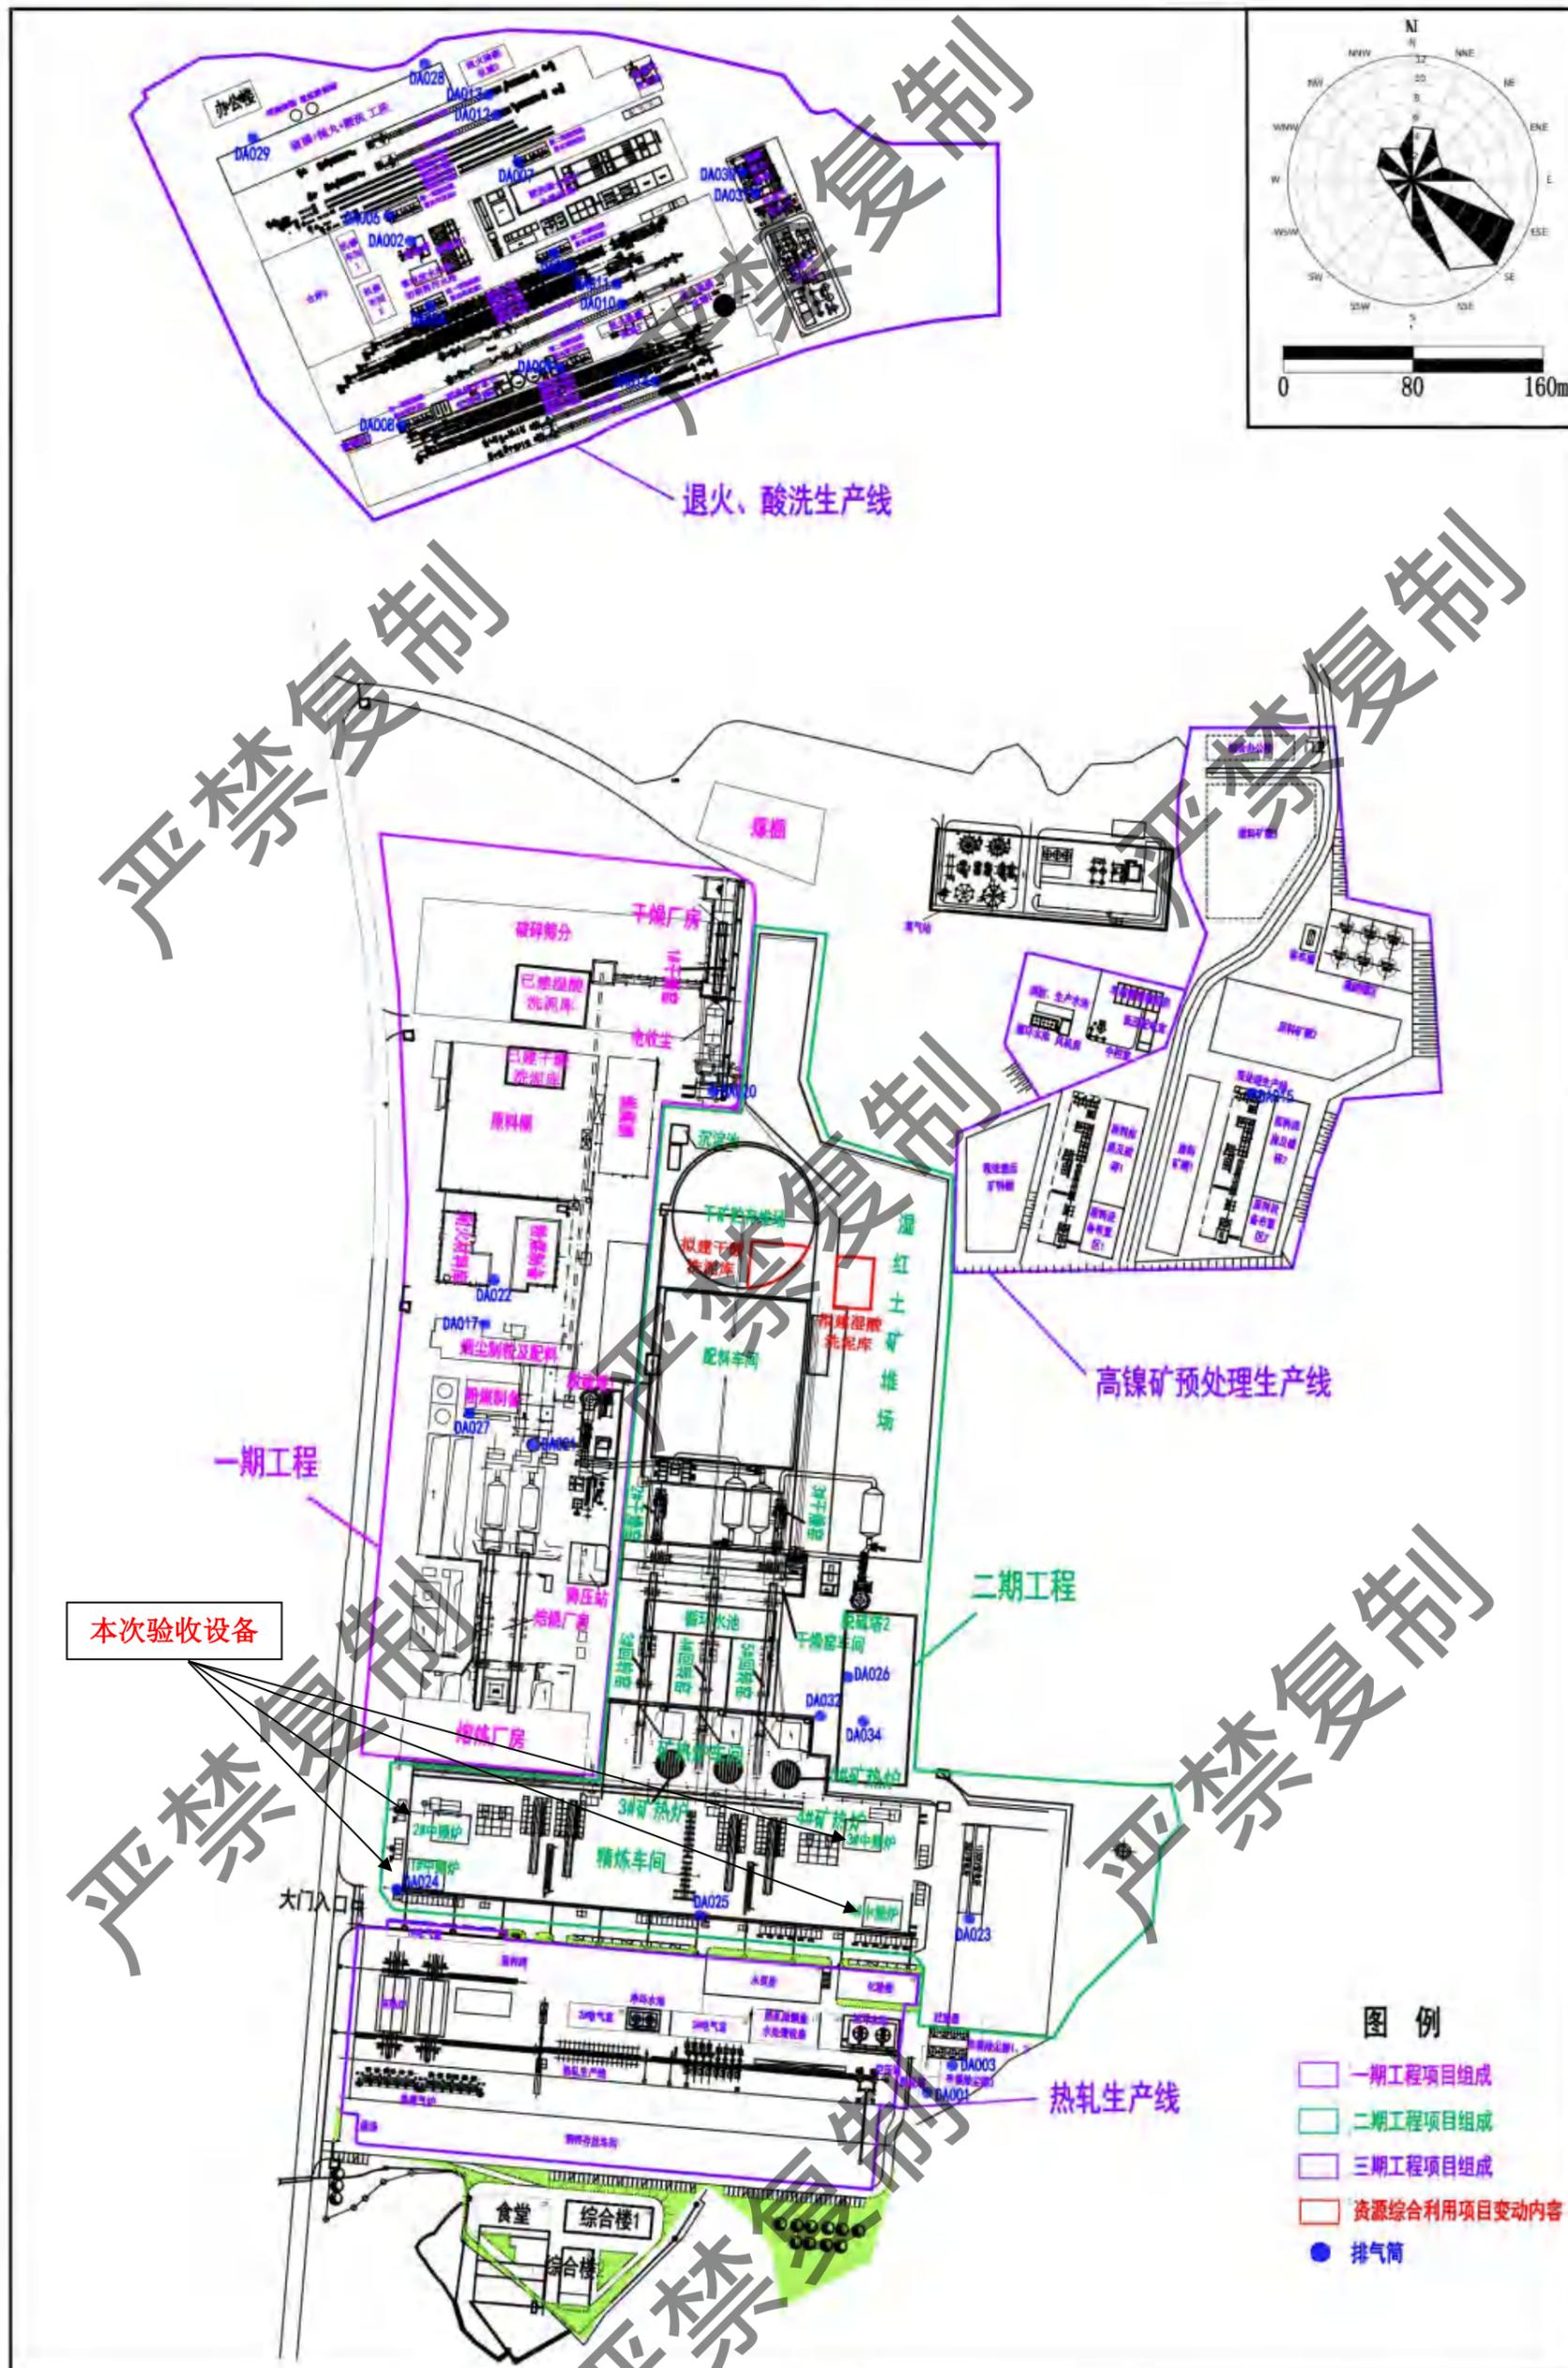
鼎信实业一期、二期、三期工程平面布置图
